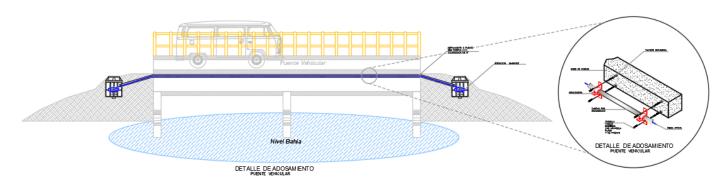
DETALLE DE ADOSAMIENTO A PUENTE PARA EL PROYECTO DE TENDIDO DE FIBRA ÓPTICA.
